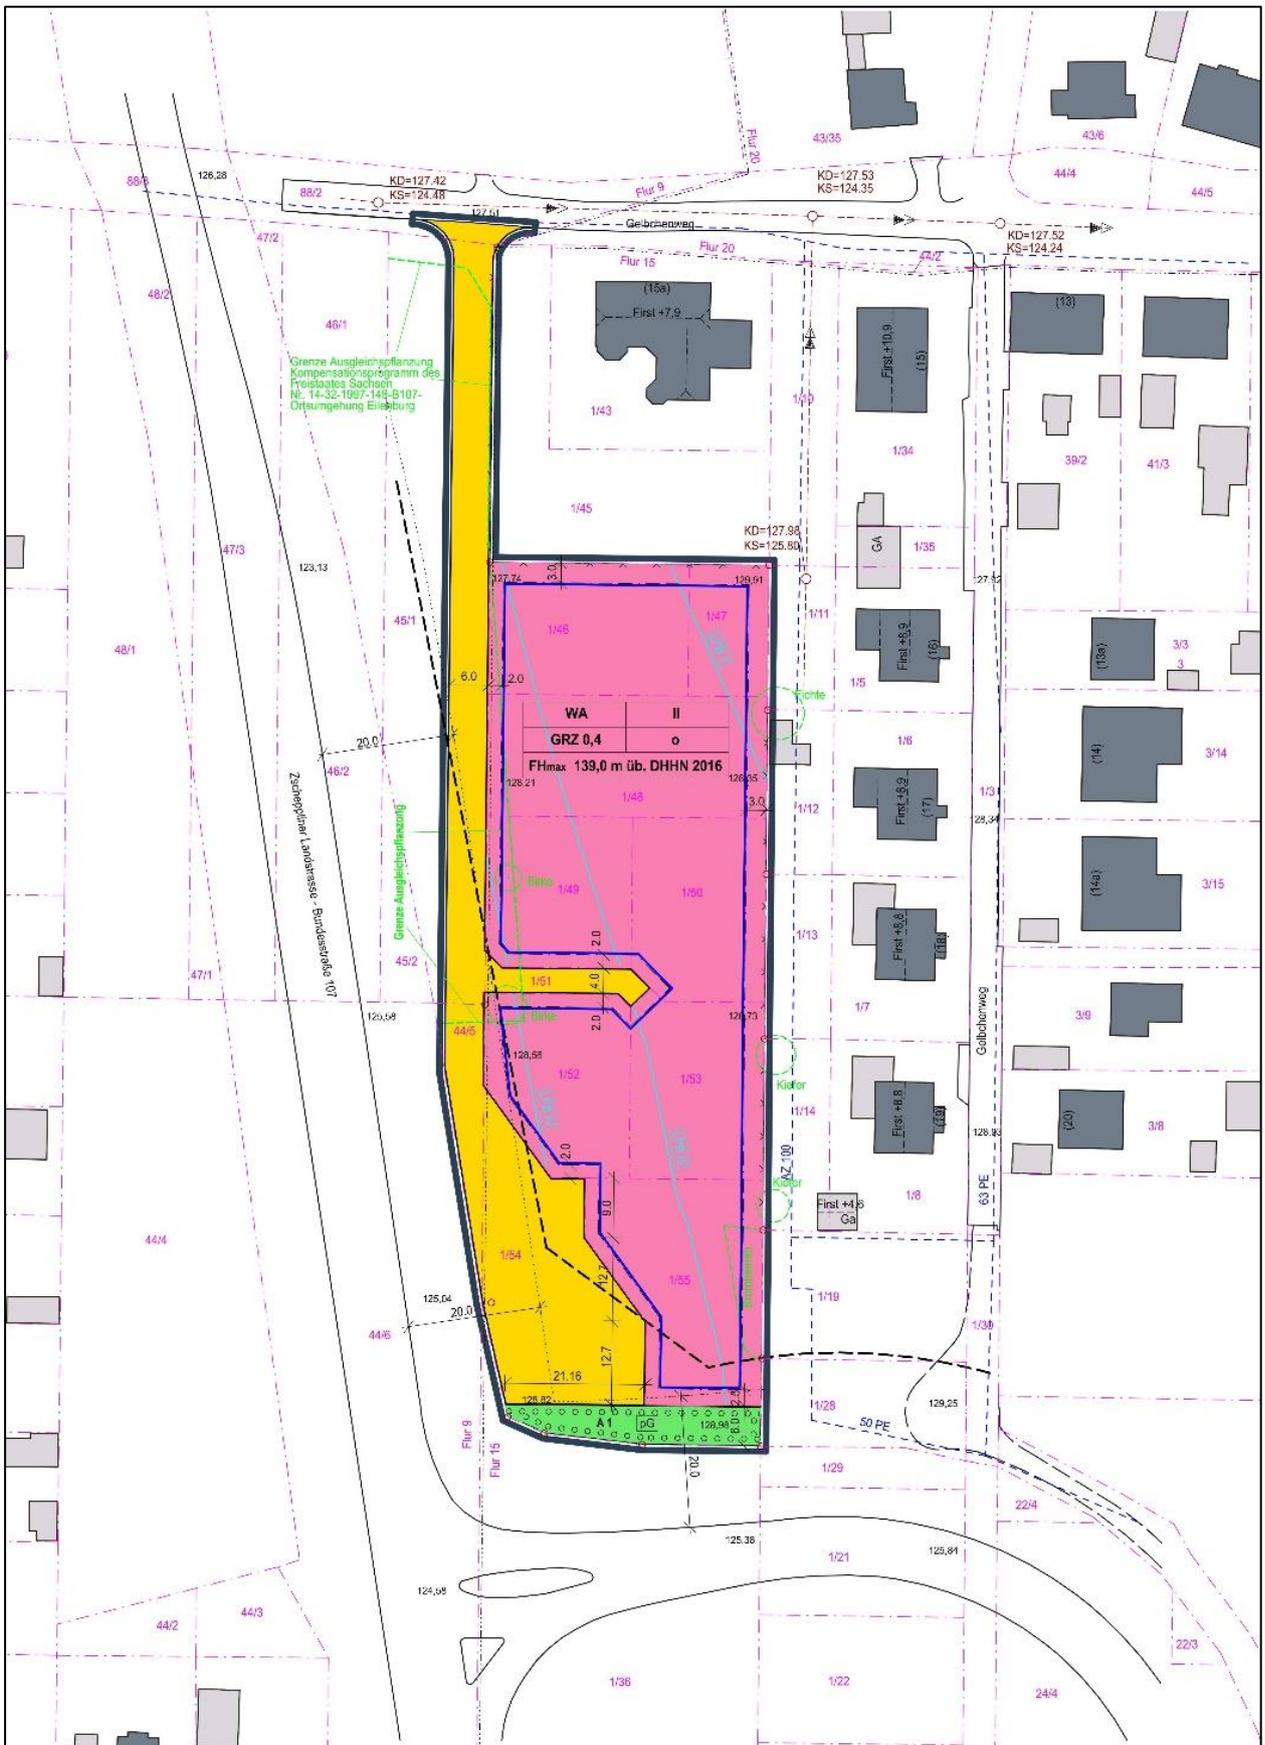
Lageplan Entwurf Bebauungsplan Nr. 57 der Stadt Eilenburg „Wohnen am Gelbchenweg“; Stand 11.08.2023 (IBS ohne Maßstab)
